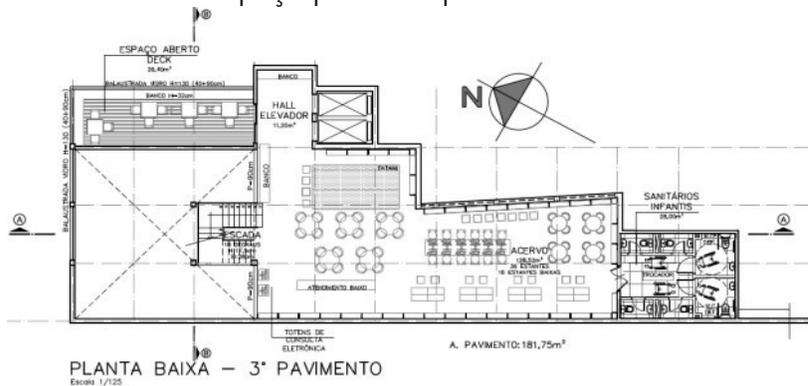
Planta Baixa 3º Pavimento - Fonte: Triple Arquitetura, 2013.
